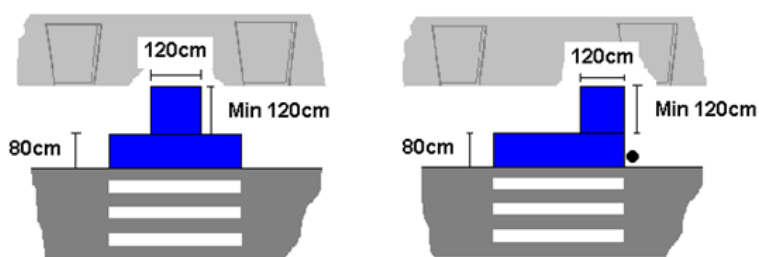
Dimensões das faixas de presença e de aproximação do pavimento tátil
